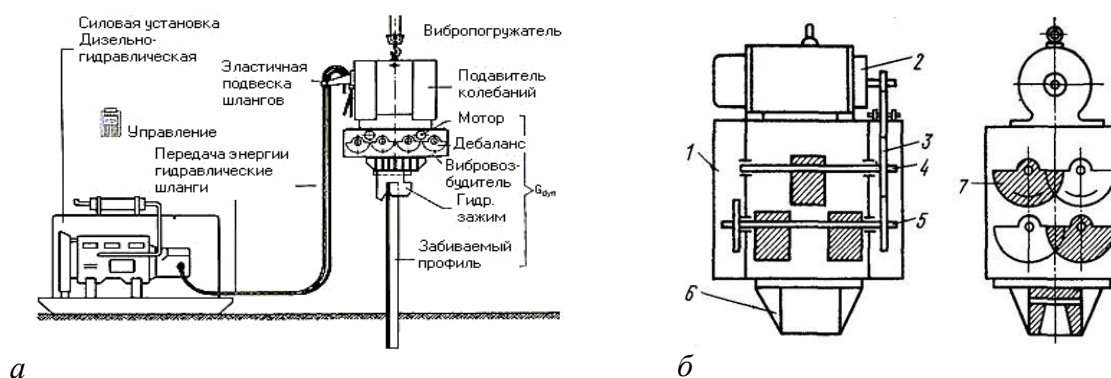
Вибропогружатели свай: а – общий принцип работы; б – схема вибропогружателя типа ВП-1: 1 – корпус вибратора; 2 – электродвигатель; 3 – клиноременная или зубчатая передача; 4 – верхняя пара валов; 5 – нижняя пара валов; 6 – наголовник; 7 – дебалансовые шайбы-эксцентрики
